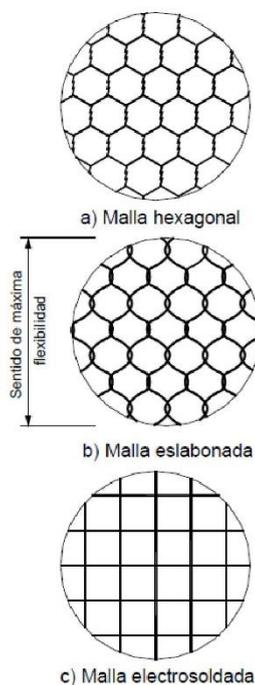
Tipos de mallas utilizadas en la construcción de gaviones. Fuente: (Suárez Díaz, 2001).
